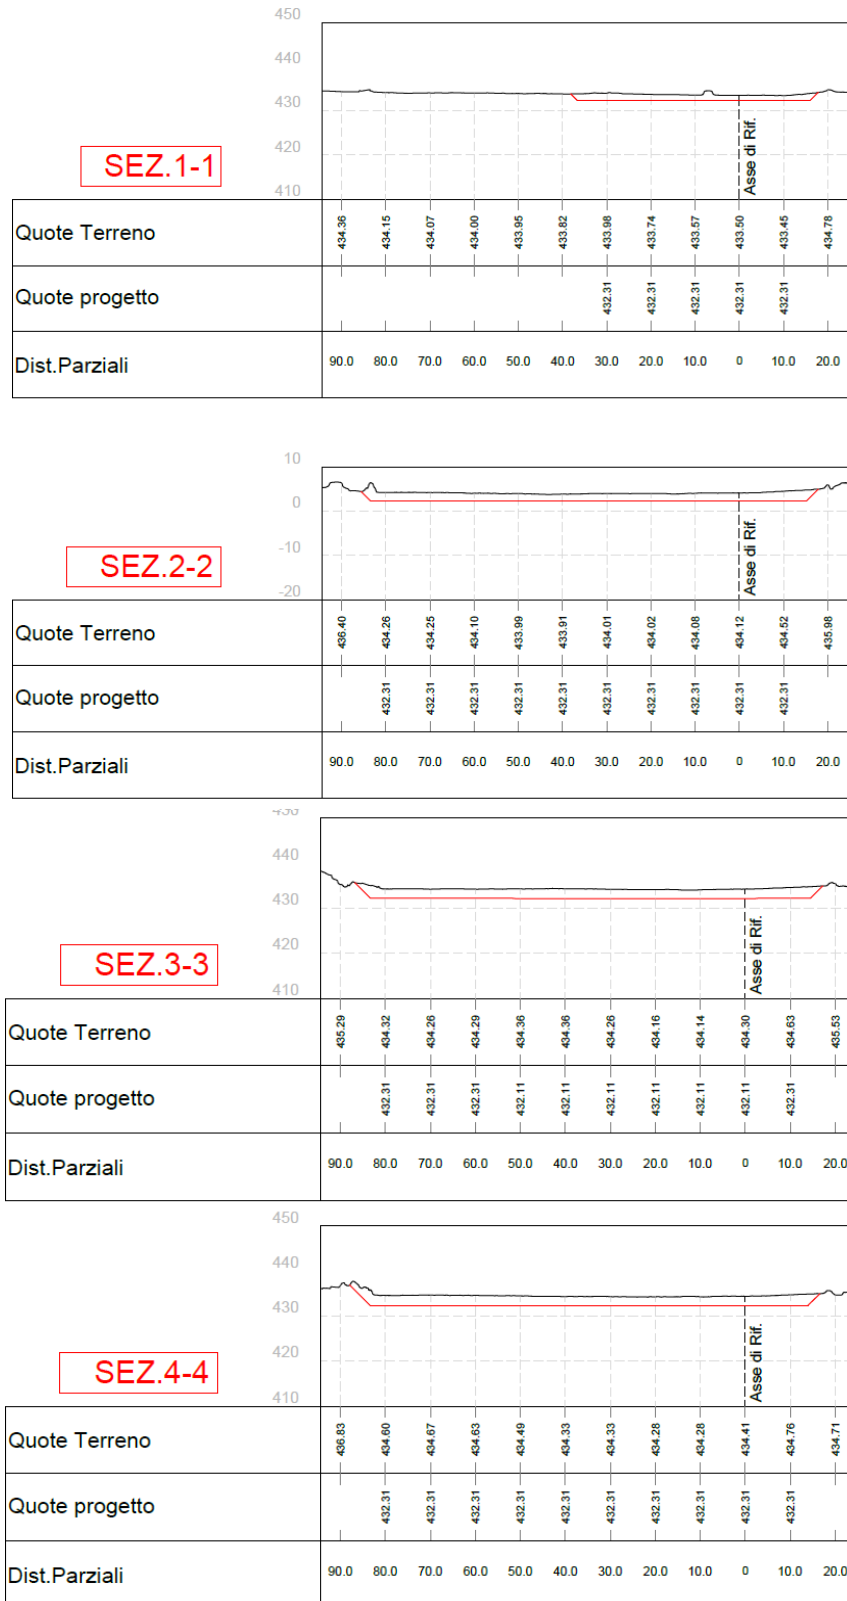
ESTRATTO DELLA TAVOLA "SCAVO E PREPARAZIONE SITO – PLANIMETRIA E SEZIONI" (COD. DC33452AC2359063)
